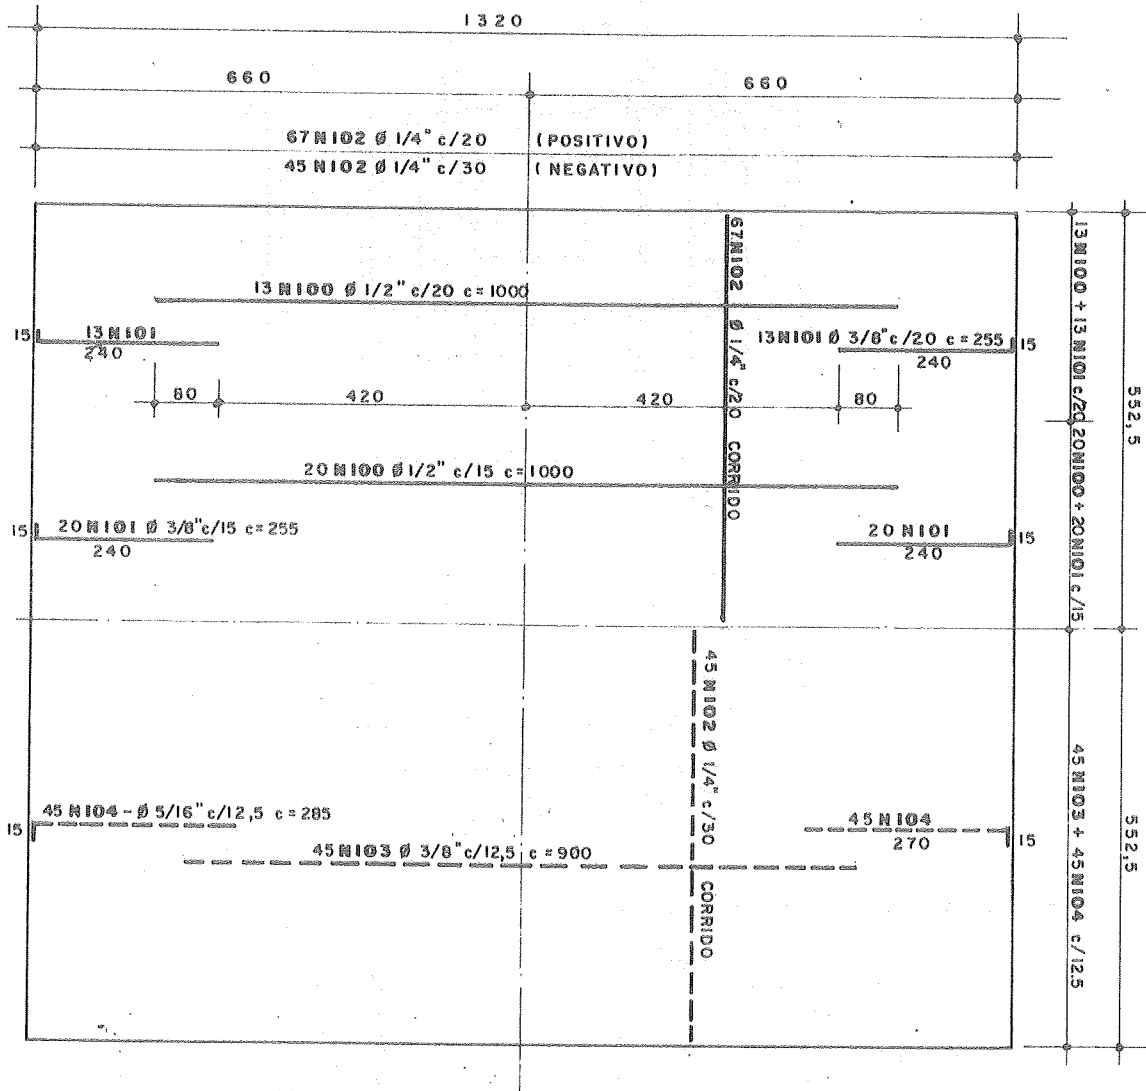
PLANTA DE ARMAÇÃO DA LAJE DO TABULEIRO
